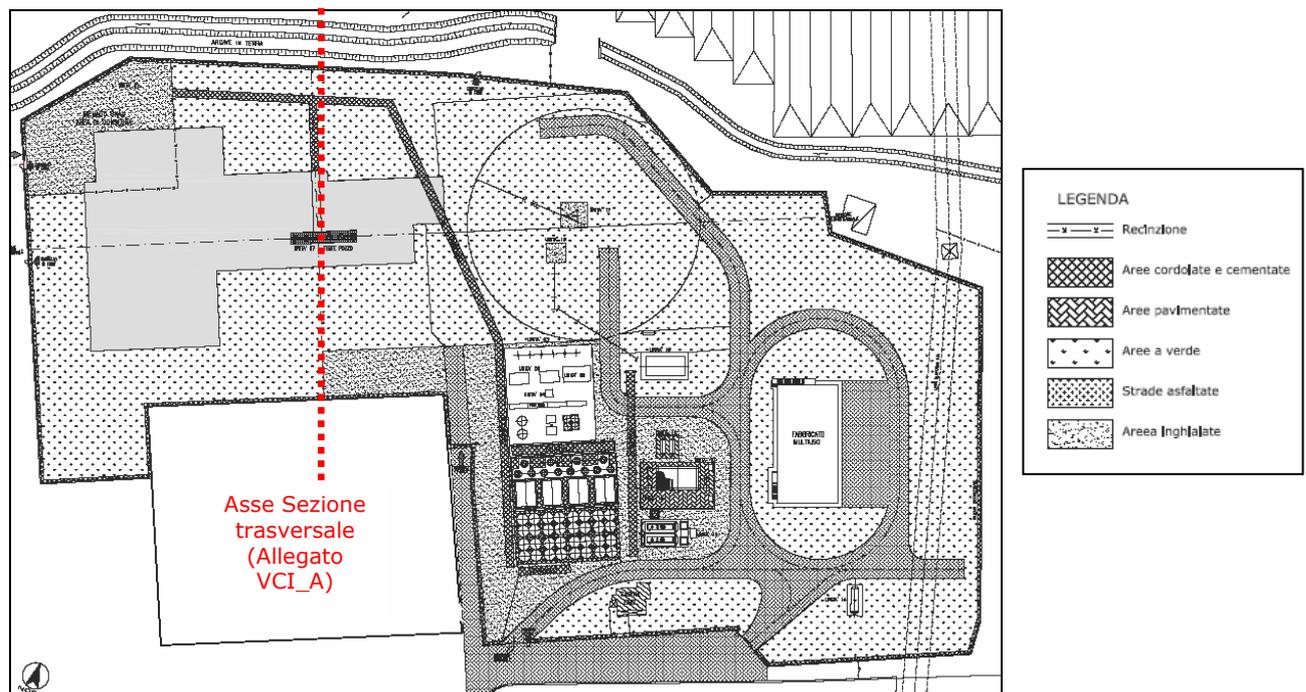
Planimetria allestimento centrale di stoccaggio gas S. Benedetto
